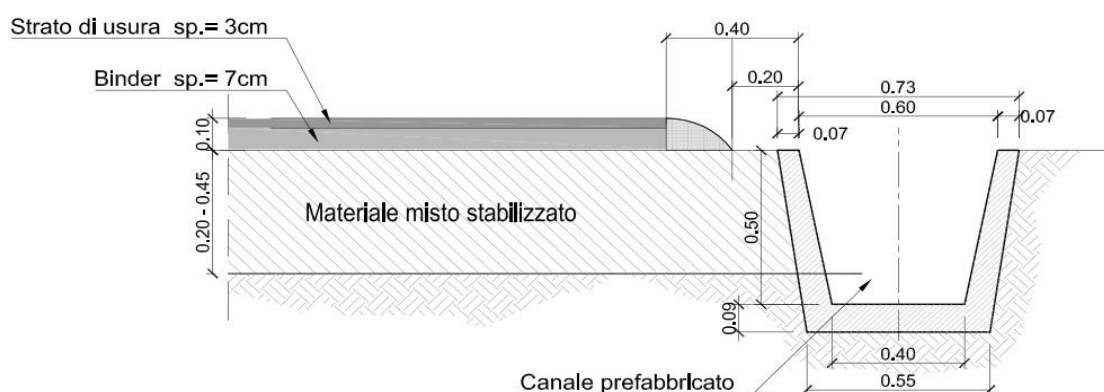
Particolare della pavimentazione e della canaletta perimetrale di raccolta delle acque.
